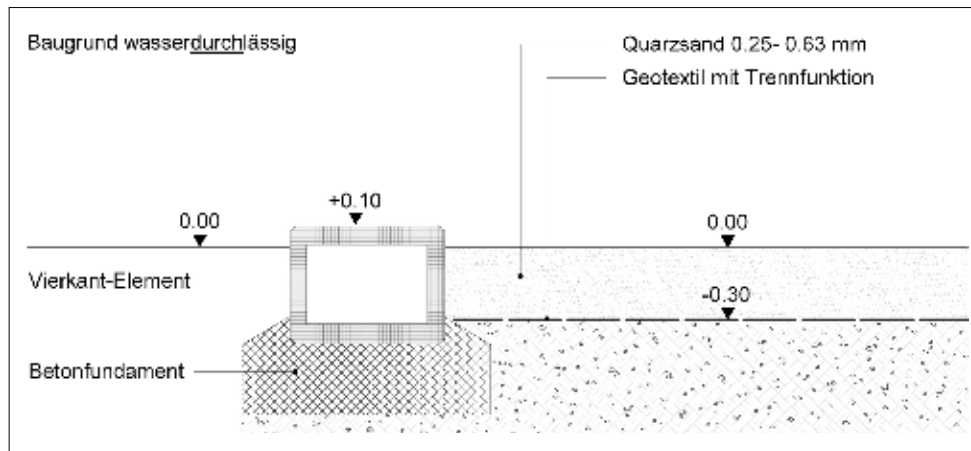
Systemaufbau für wasserdurchlässigen Baugrund
